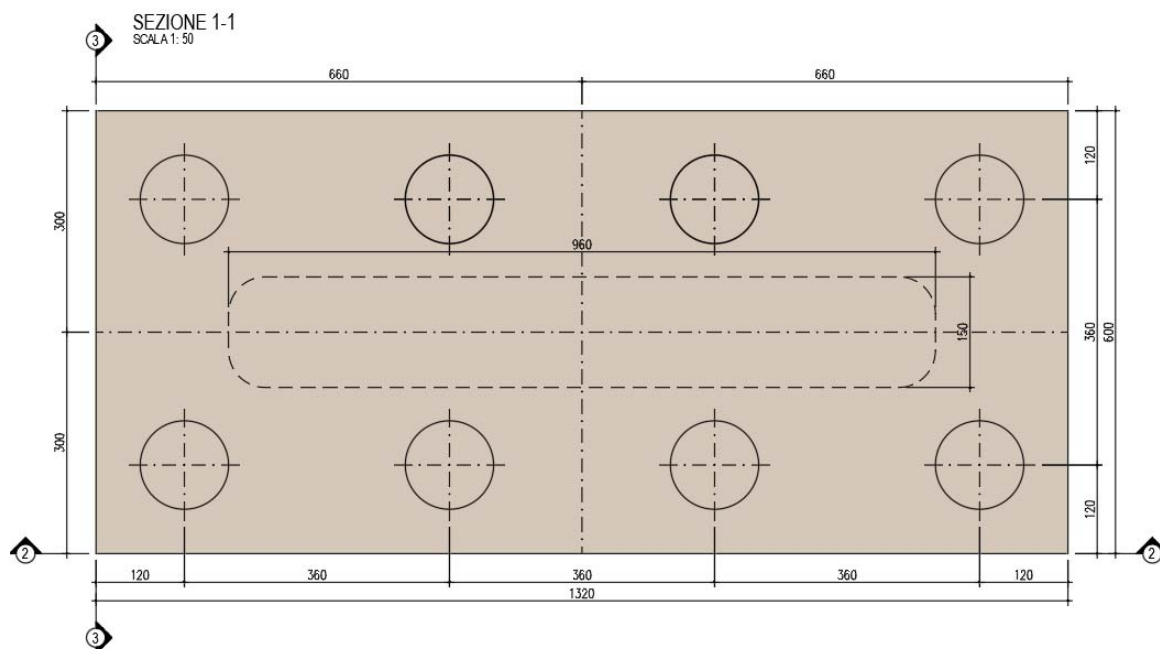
Pianta fondazioni P1, P2, P3, P4
